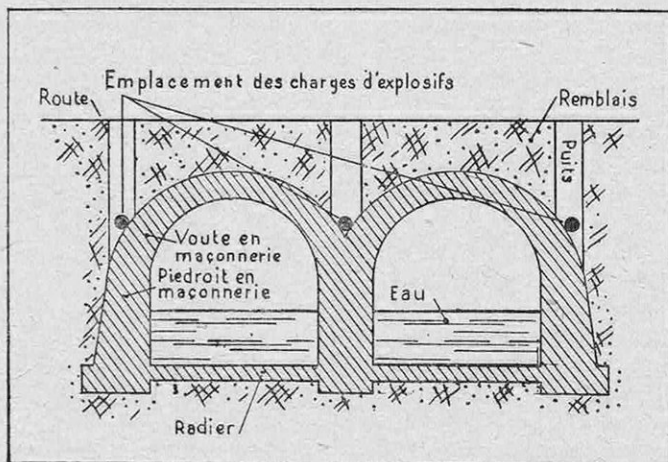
PRINCIPE DE LA DESTRUCTION D'UN PONT SOUS REMBLAIS, A DEUX ARCHES ACCOLÉES EN MAÇONNERIE
